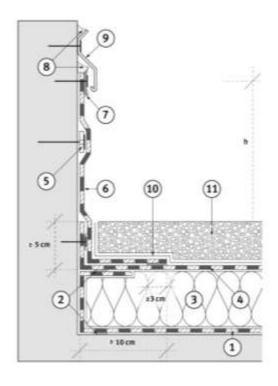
Cas d'un pare-vapeur bitumineux sur élément porteur en maçonnerie (dans le cas de plancher de type D, planchers chauffants, fixation obligatoirement dans la partie verticale du relief. Cf § 10.2), hors locaux à très forte hygrométrie
